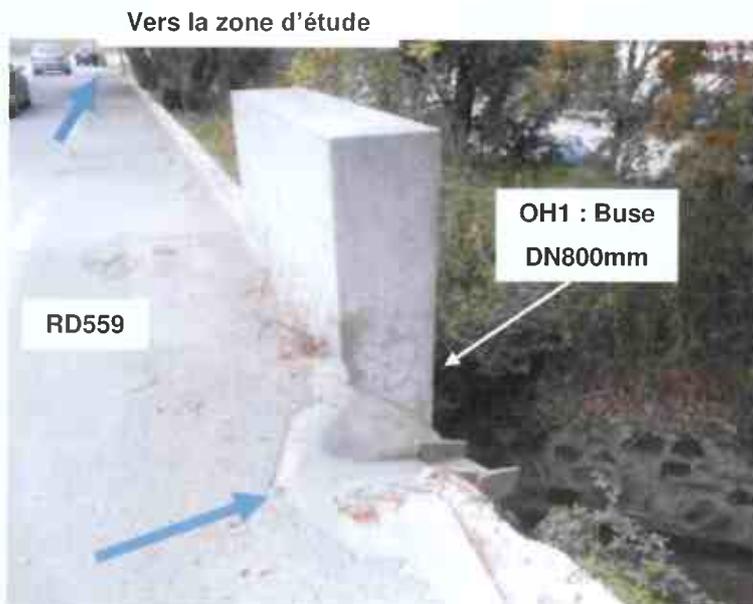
Ouvrage de traversées et passage d'eau sur la RD559
